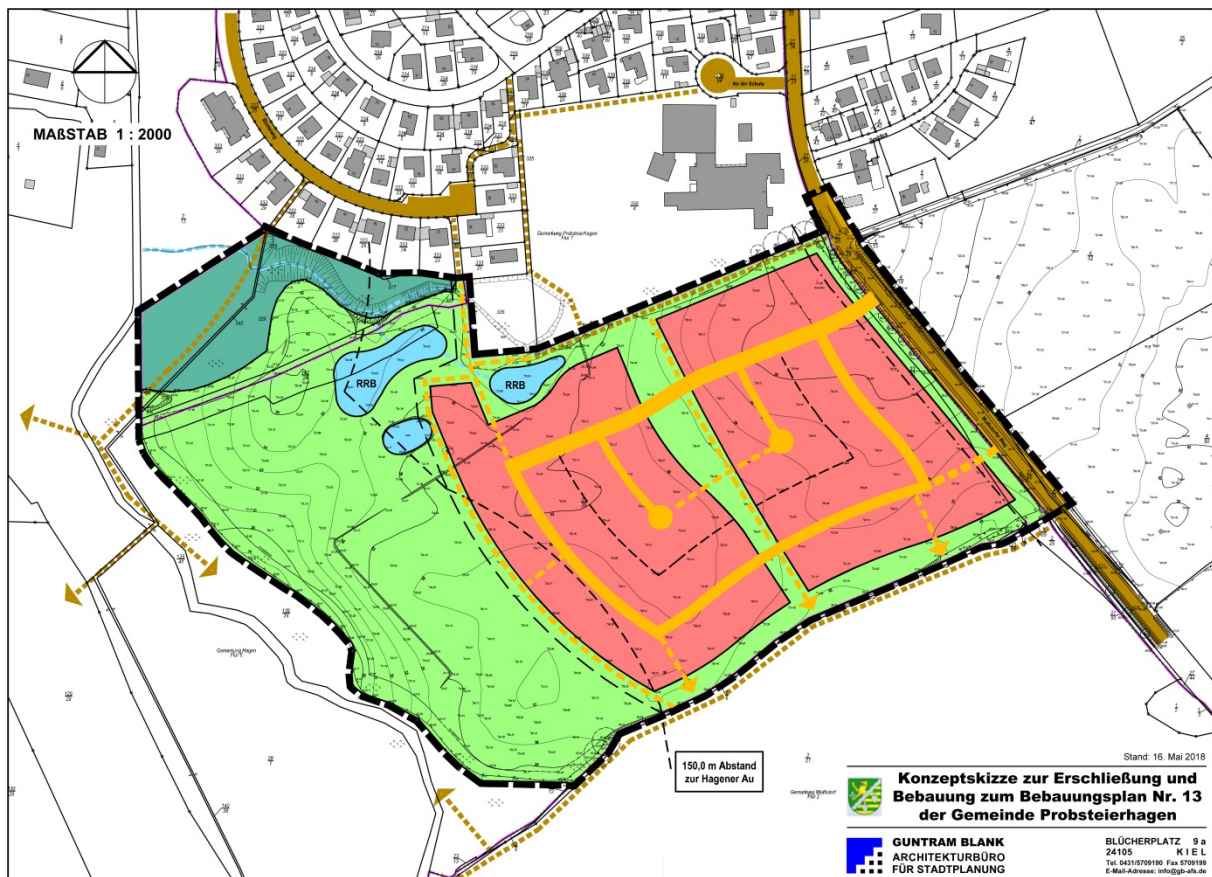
Geplante Wohnbauflächen, Abstandsfläche zur Hagener Au, Waldabstandsflächen, Regenrückhaltung (Vorplanung) (Quelle: Guntram Blank, Architekturbüro für Stadtplanung)
